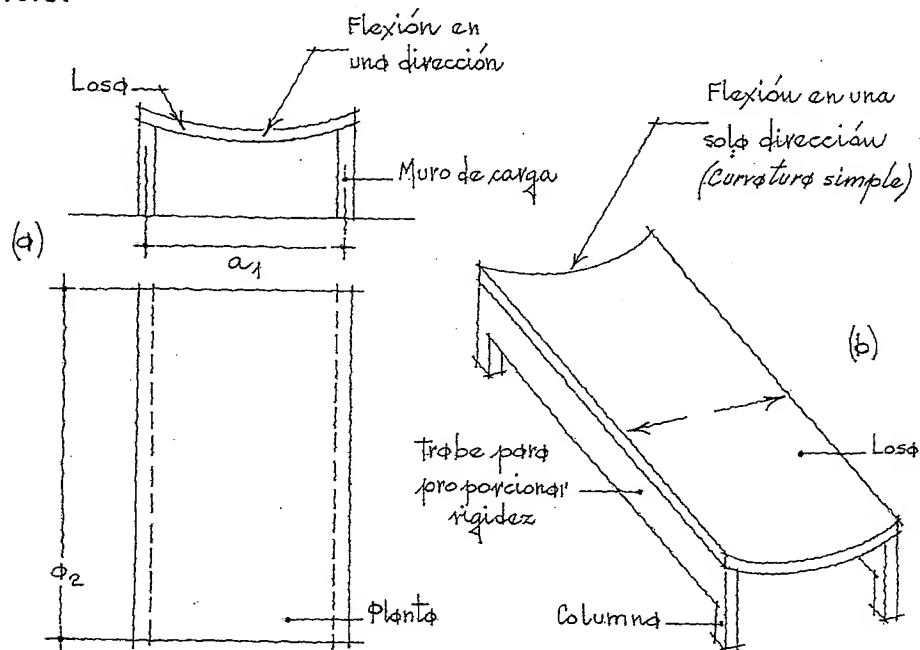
Losa apoyada sobre columnas y trabe rígida, (b).
